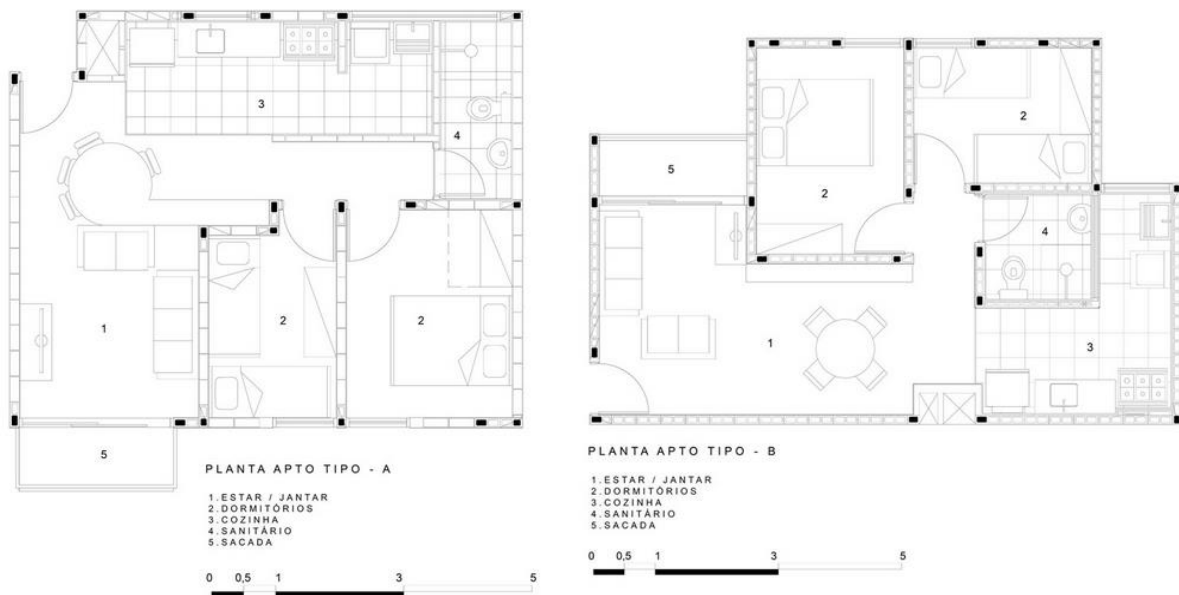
Plantas tipos A e B da SEHAB Heliópolis.
